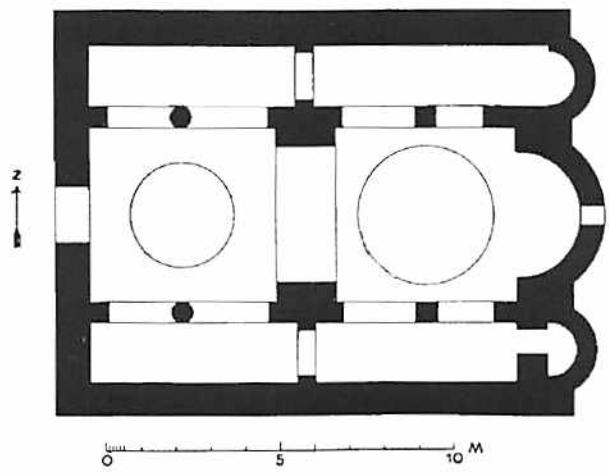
'San Pietro' di Crepacore, planimetria storica / 'San Pietro' di Crepacore, historischer Grundriß (da / nach: BERTAUX 1903, fig. 173 e DE GIORGI 1888).
